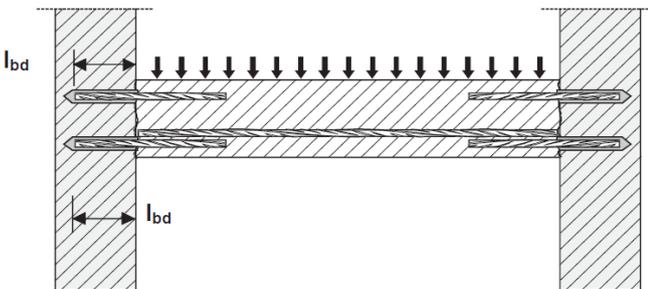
Jonction à recouvrement pour liaison de barres d'armature de dalles et poutres
